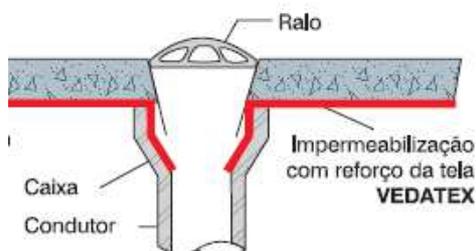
Detalhe da impermeabilização e grelha dos ralos
